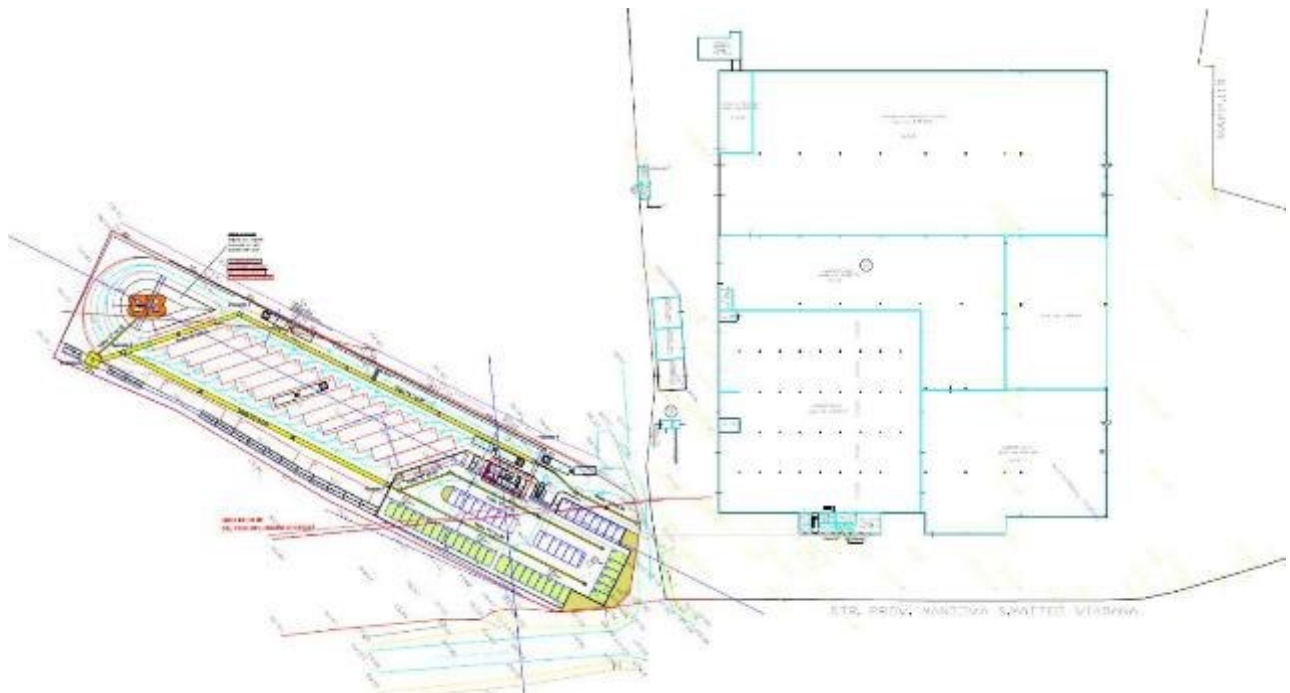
estratto planimetria di progetto (non orientata a nord). [A destra stabilimento esistente]
